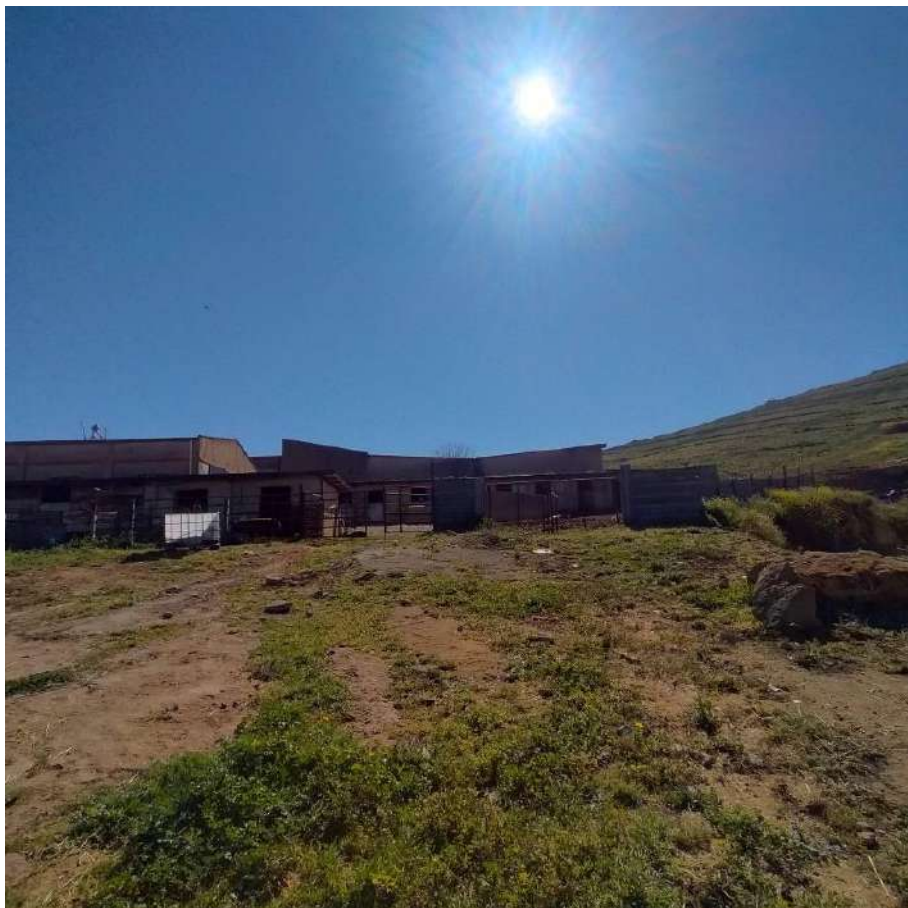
EDIFICIO 3 VISTA LATERALE (MAGAZZINI E DEPOSITO)
